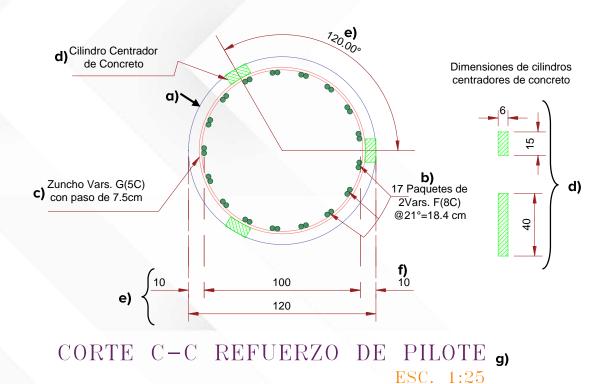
Ejemplo de refuerzo de pilote, corte C-C
